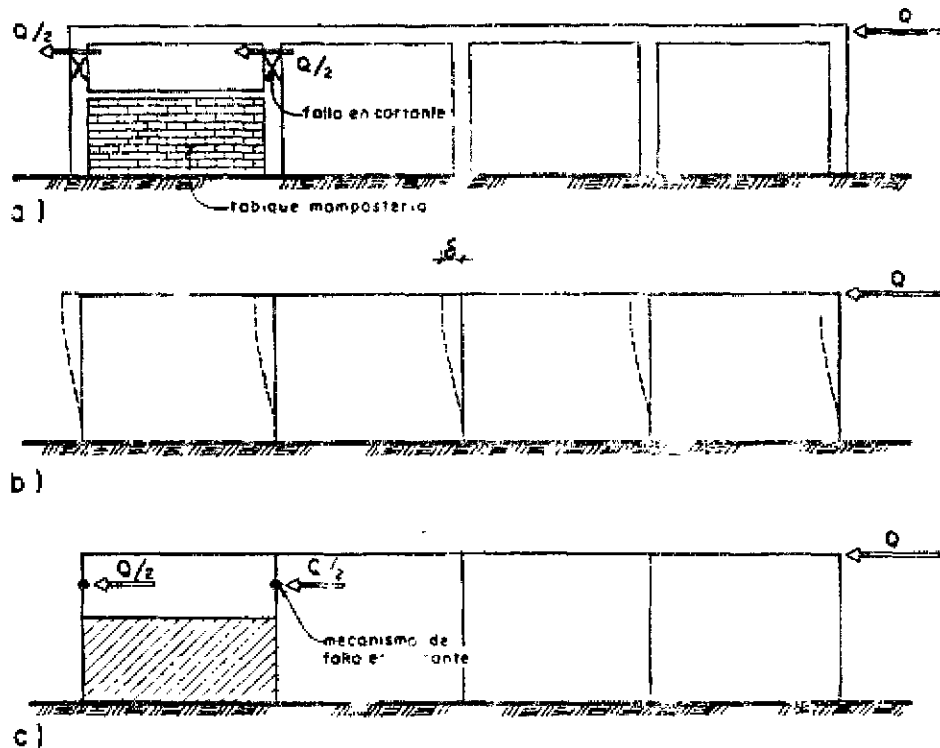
Efecto de columna corta - a. Pórtico restringido parcialmente por tabique de mampostería - b. Libre deformación del pórtico sin restricción de tabiques - c. Deformación restringida por tabique y mecanismo de falla en cortante.
